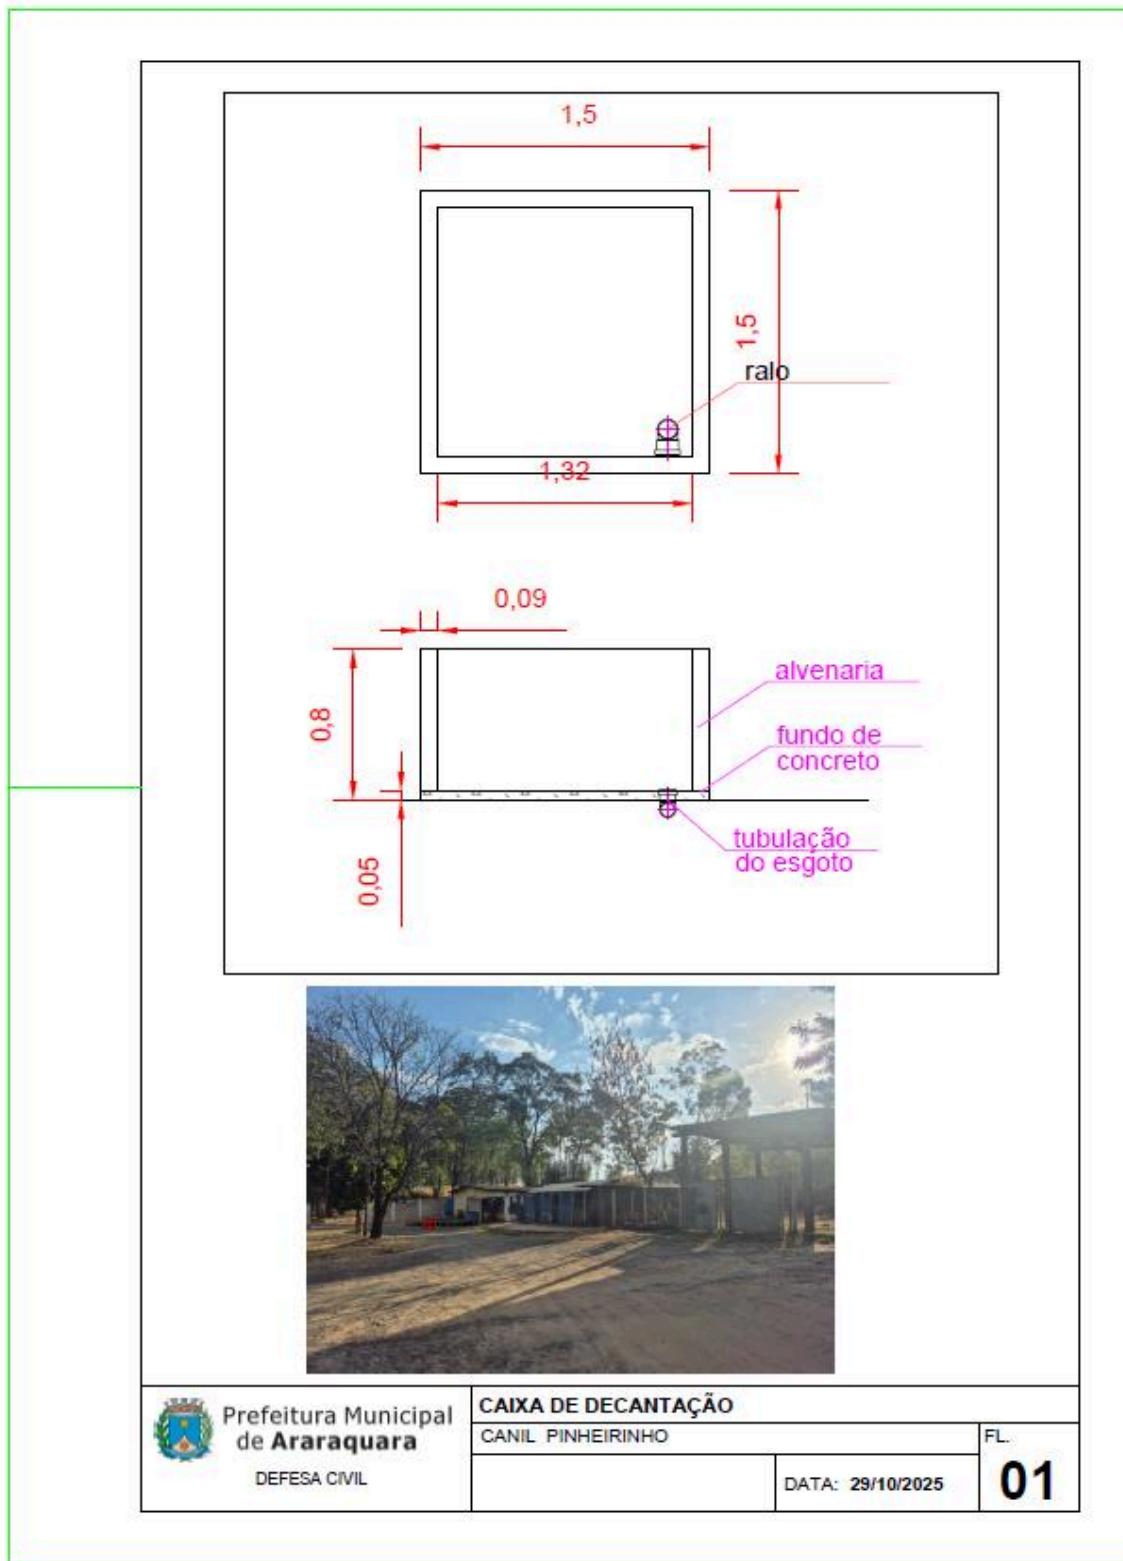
Planta baixa da Caixa decantação defronte ao Canil
